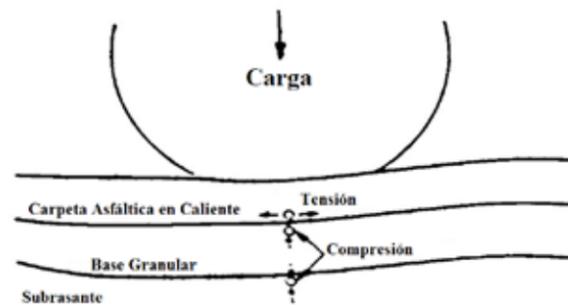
Transmisión de Esfuerzos en las Capas que Componen un Pavimento Flexible.
